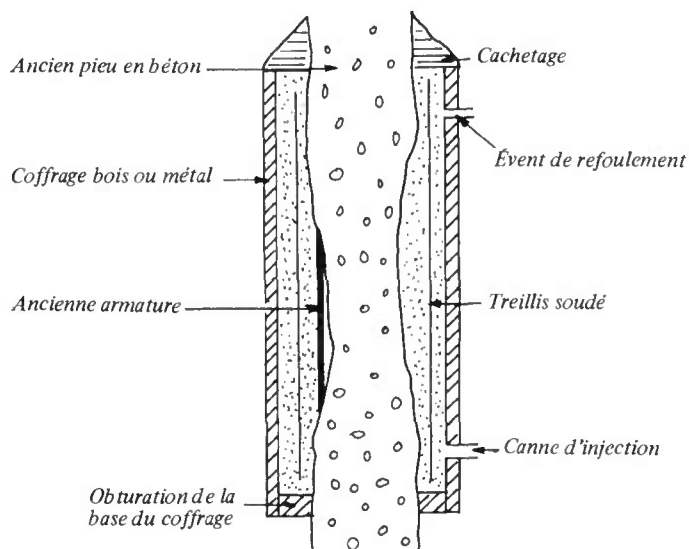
Principe de la réparation d'un pieu en béton par gainage.
